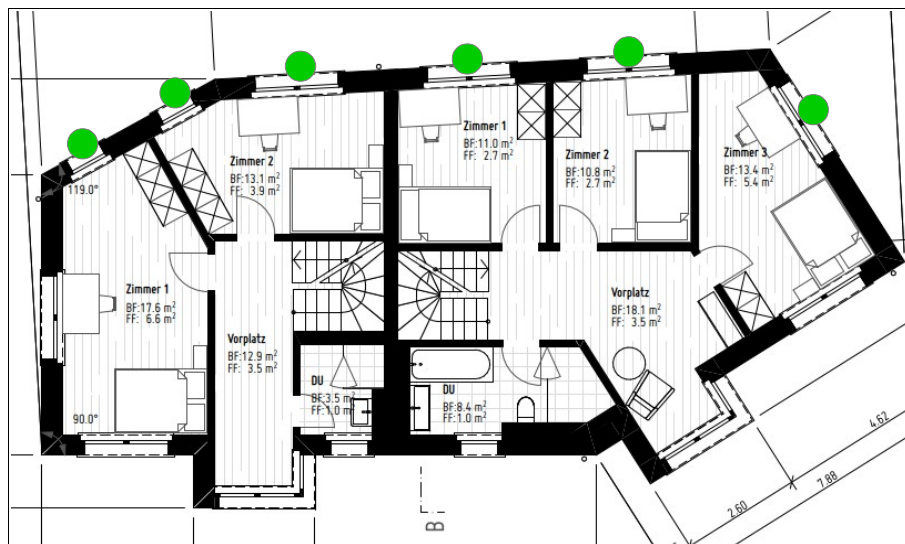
Grundriss 1.OG, ohne Mst.; Quelle: Architekt
